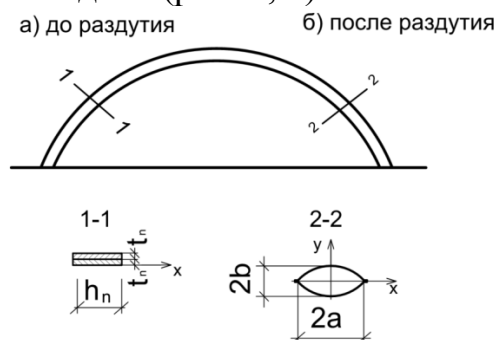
Арка из элемента сварногнутого профиля
